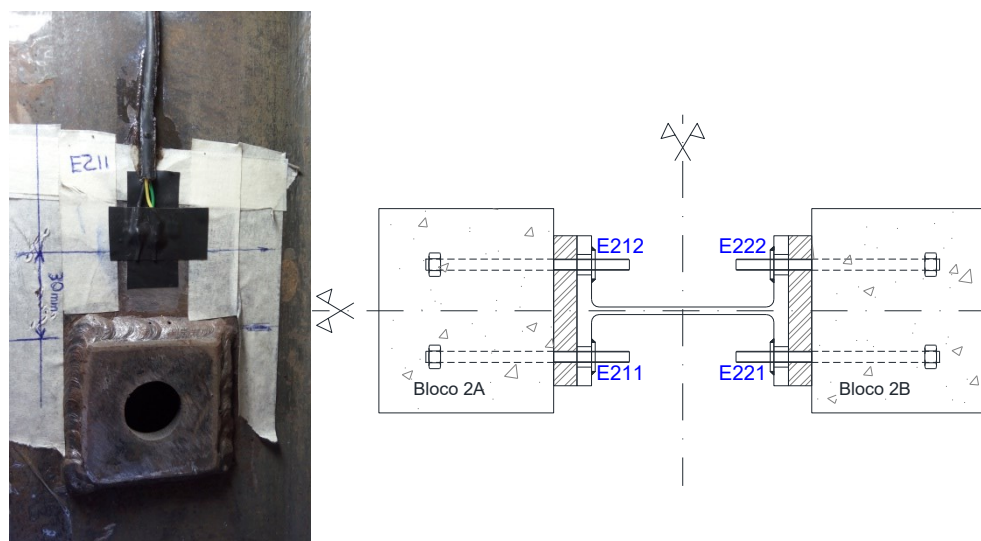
Posição dos extensômetros no perfil para o Ensaio 2.
